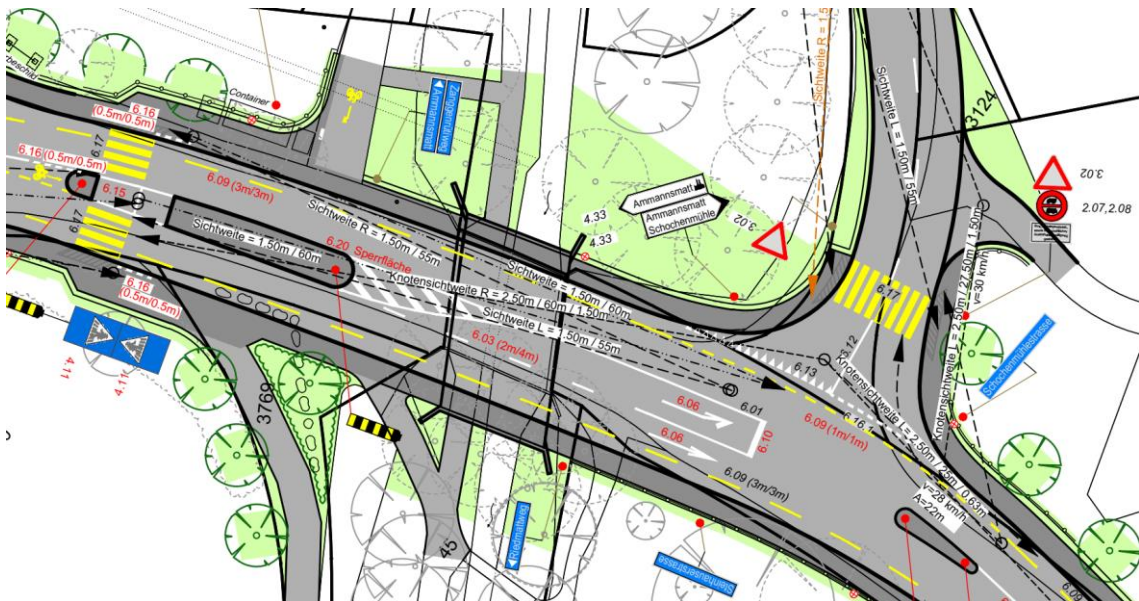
Übergang Lorzen-/Zanggenrütiweg mit Knoten Schochenmühlestrasse
